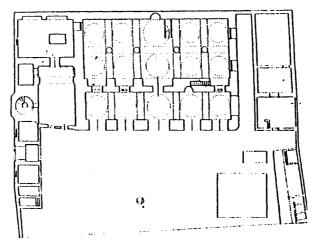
مسقط أفقي لجامع عبد القادر الجيلاني ببغداد (عن Ulucam).
